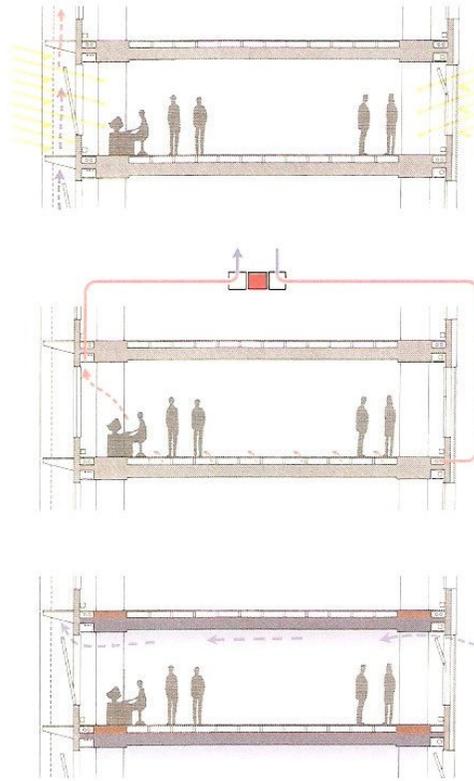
Corte esquemático demonstrando opções de ventilação e aquecimento pela fachada dupla.
